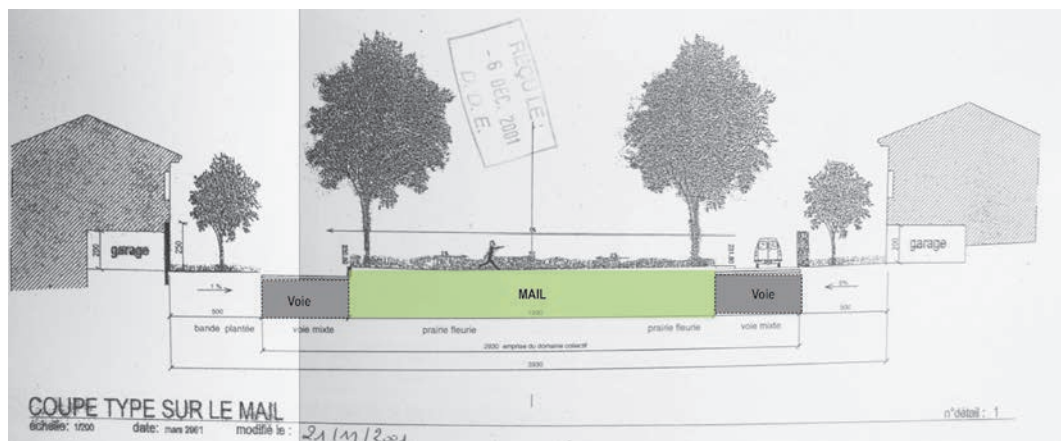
Coupe sur le mail (source : Dossier de demande d'autorisation de lotir /Cahier des charges paysagers et technique/In Situ, 2001)
